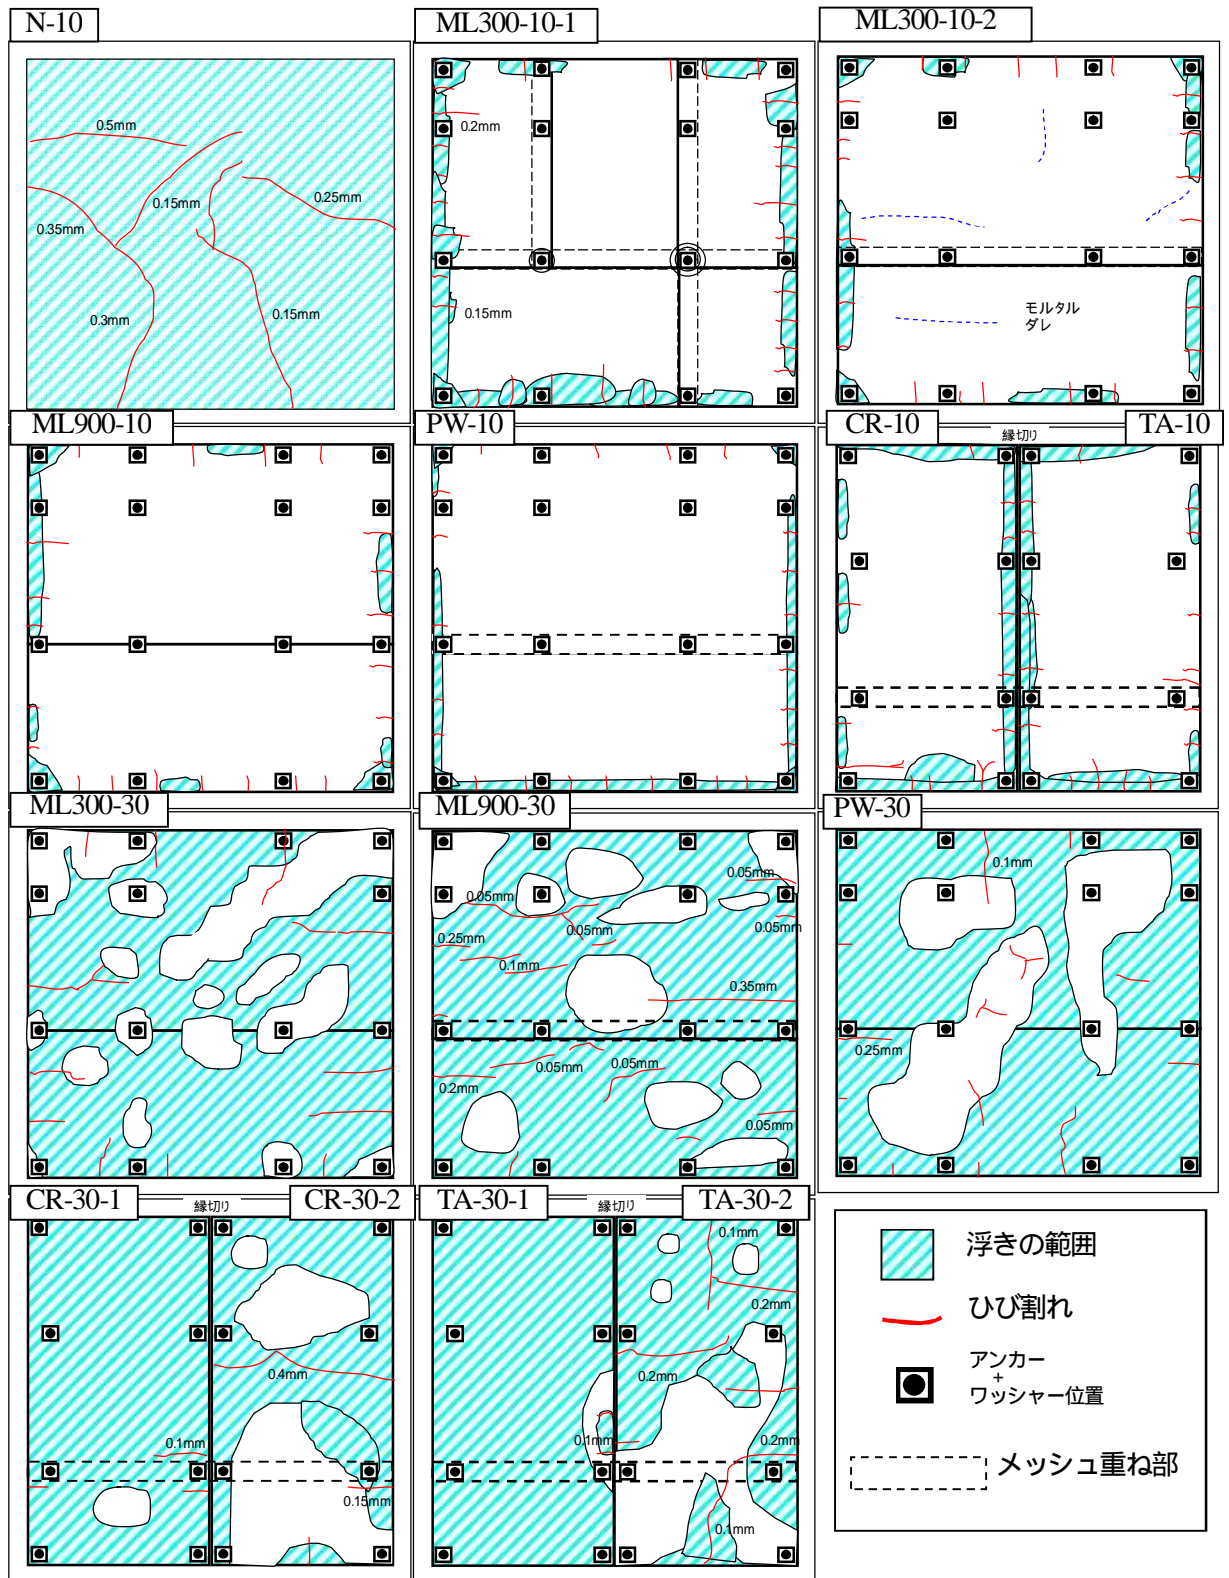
試験体の浮き・ひび割れ発生状況 (加熱前)
